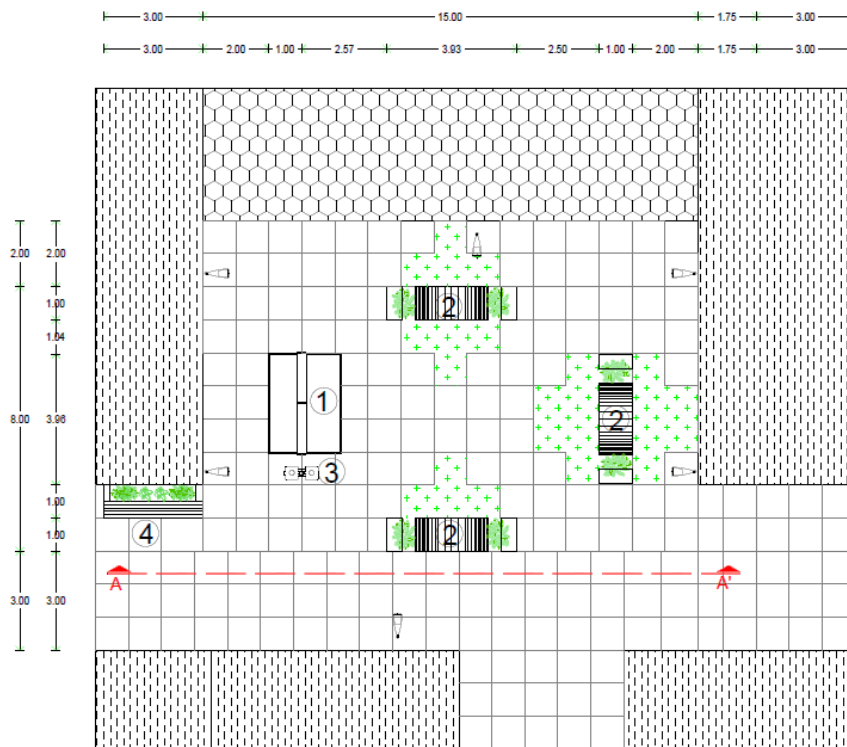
Planta arquitectónica de la plaza 8. Se observa la distribución del mobiliario ocupado y el cambio de piso.
